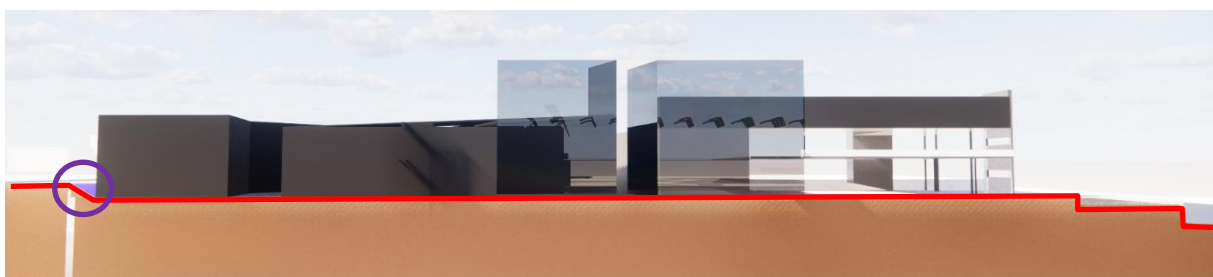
Coupe d'implantation du projet. (Source: Auteur)
